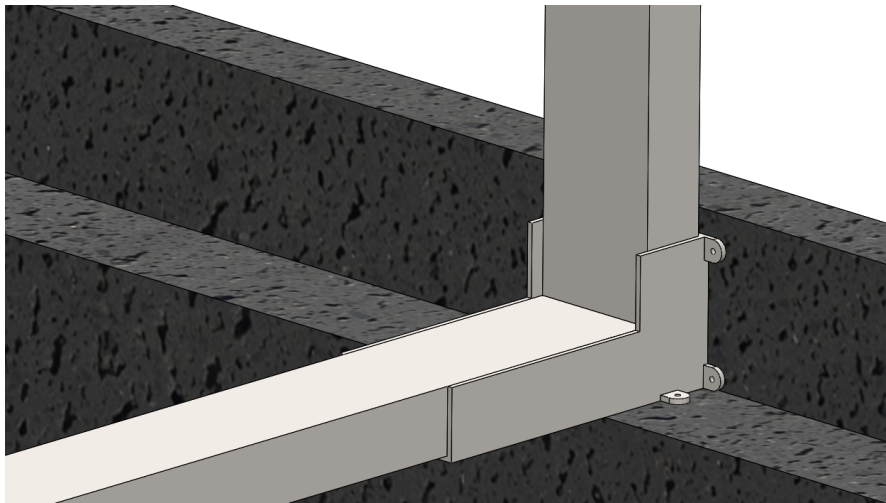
CAD final do encaixe da viga do chão com o pilar da parede.
